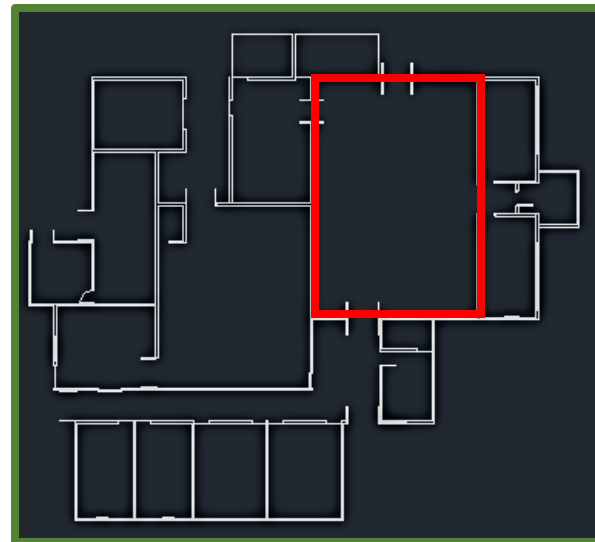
Análisis de Planta Arquitectónica Servicios Generales
